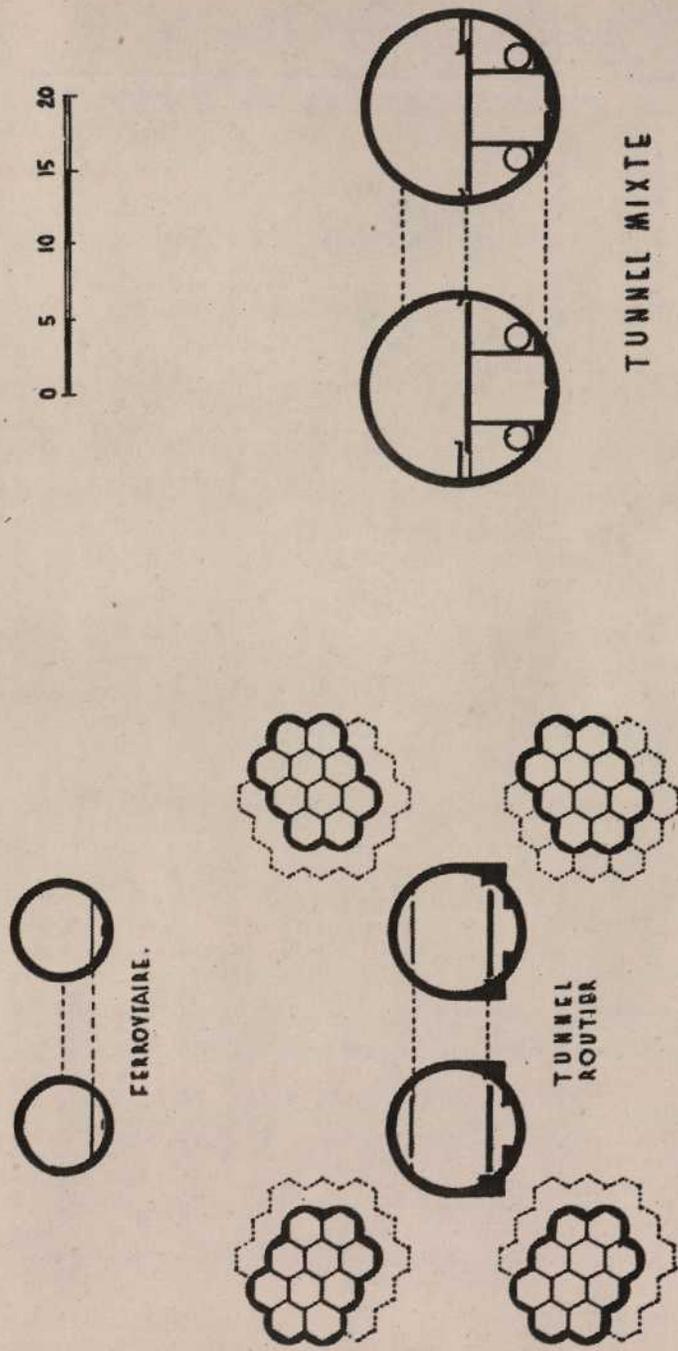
Comparaison des divers projets (sauf le tunnel mixte 1948)
